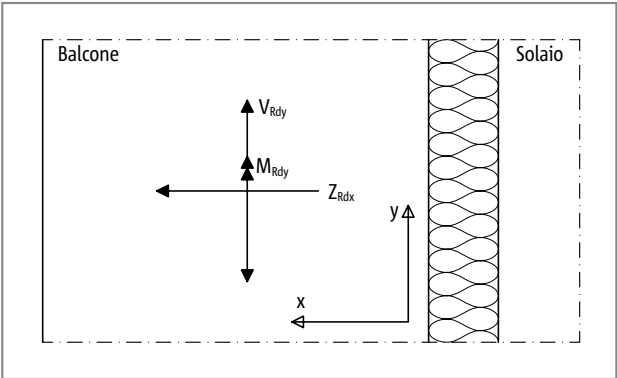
Schöck Isokorb® tipo EQXT: regola dei segni per il dimensionamento
